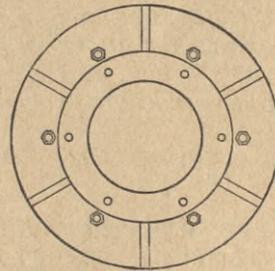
c. Kellerabdichtung nach Boon. [Handbuch für Eisenbetonbau.]
